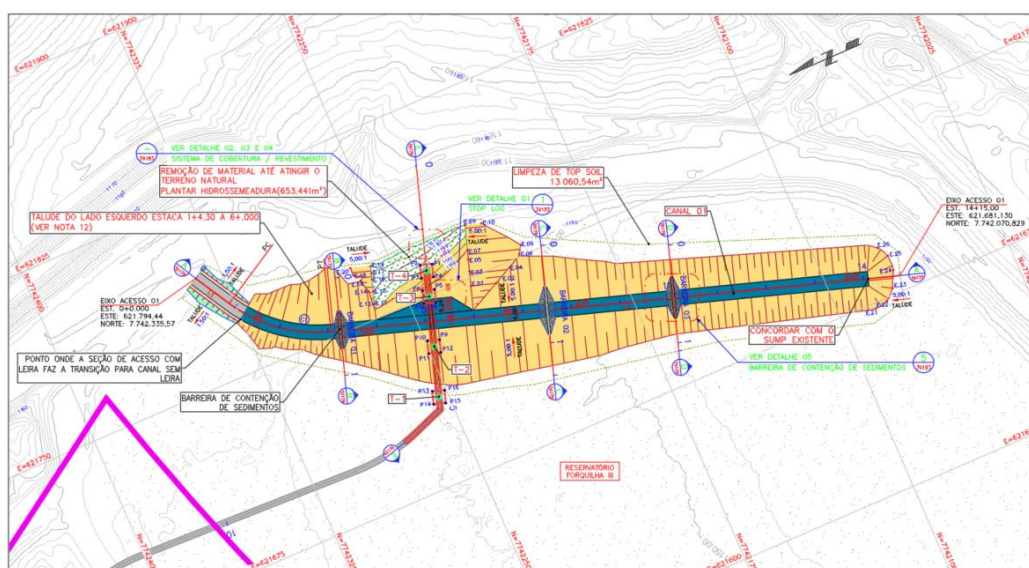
Arranjo geral do projeto de rebaixamento do extravasor, projeto 1850HH-X-39177 (Fonte: KCB, 2023).
